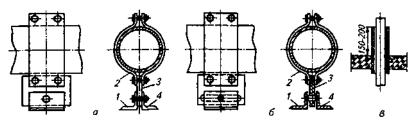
Конструкции опор трубопроводов: a — неподвижная; δ — подвижная; ϵ — гильза; 1, 4 — опорные уголки; 2 — хомут; δ — башмак
